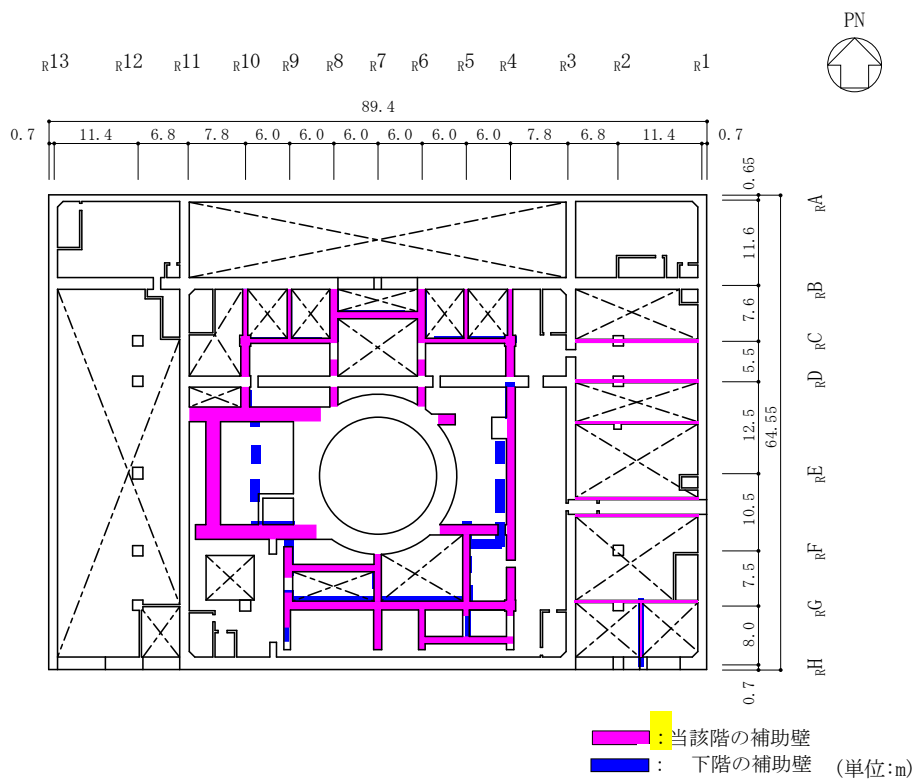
(4) 補助壁の配置図 (EL 30.5m)
